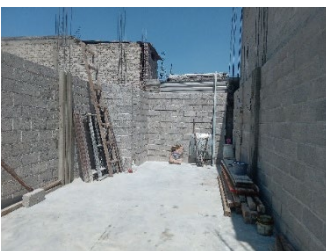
Foto de columnas fundidas con los muros perimetrales.
